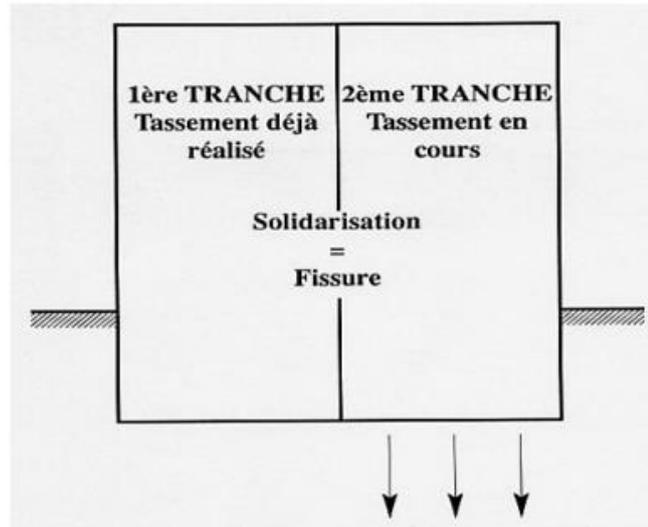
Tassement différentiel des fondations-Bâtiment construit en plusieurs tranches.
